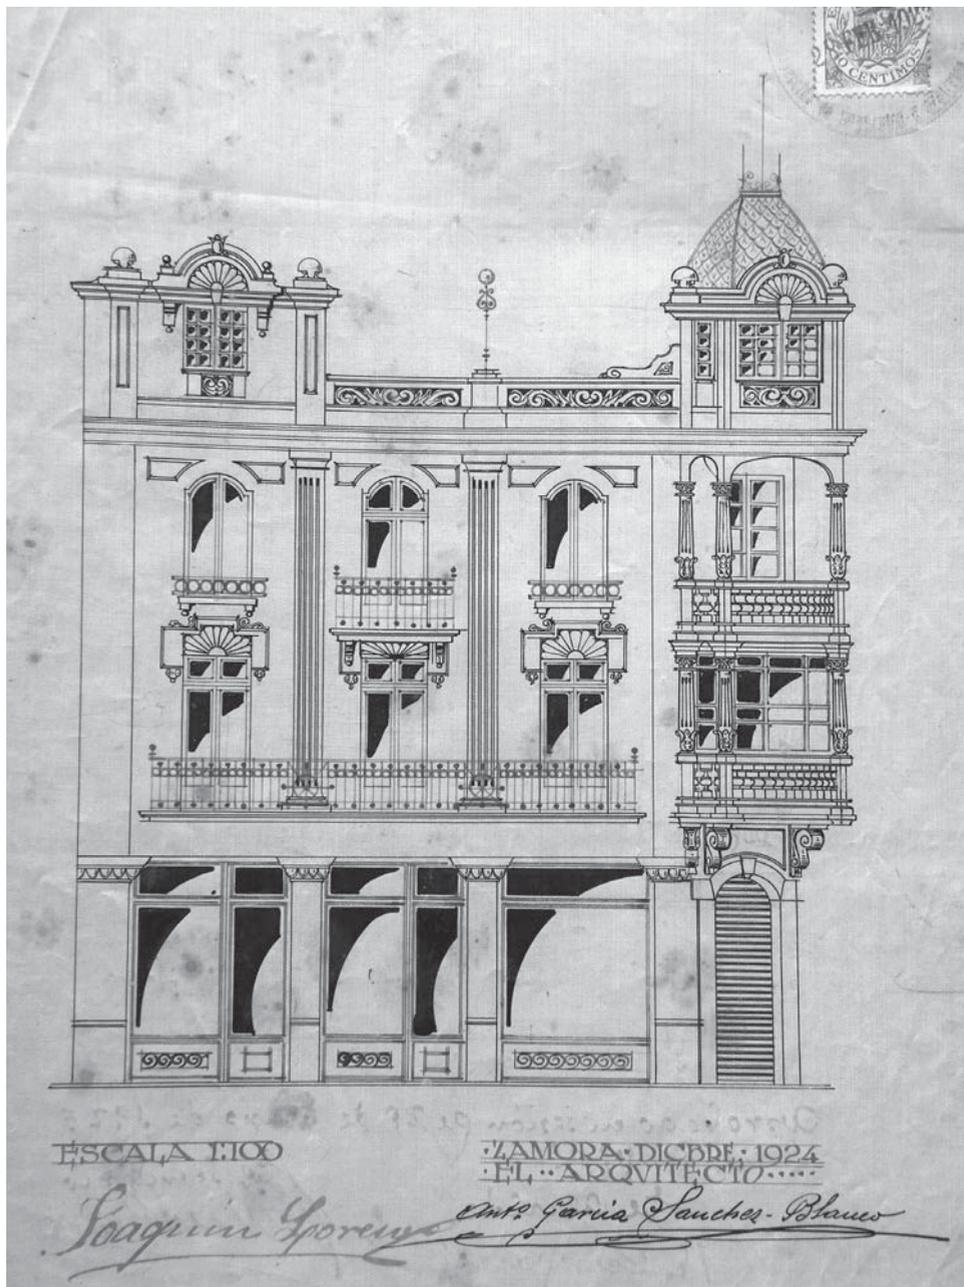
Edificio Las Tres Tiendas, proyectado por Antonio García Sánchez-Blanco. Plano de Alzado a la calle de la Feria. Diciembre 1924. (ALTT).
